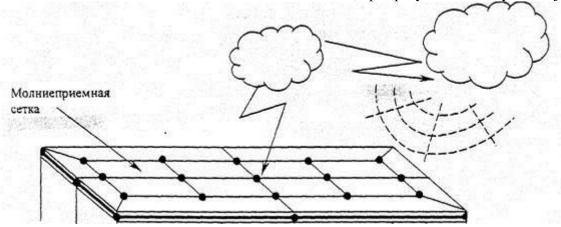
Расположение молниеприемной сетки на кровли здания
